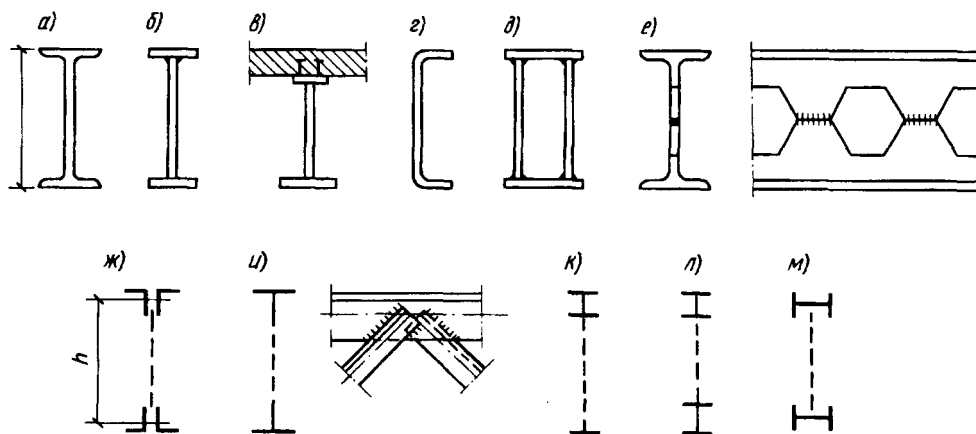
Типы сечений ригелей, балок и ферм перекрытий
